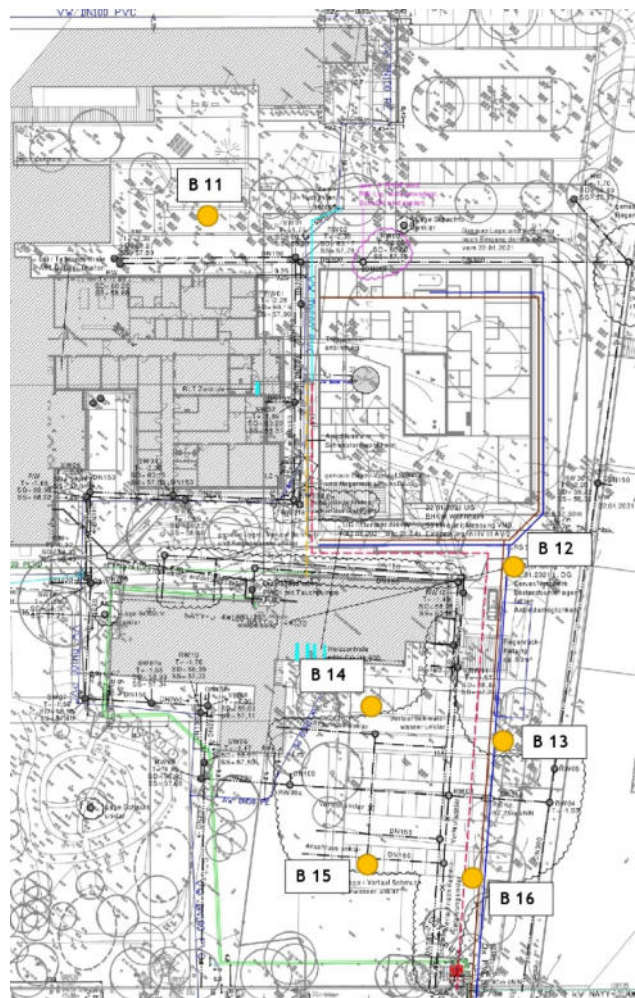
Bohrprofile und Lageplan der Erkundungsbohrungen
